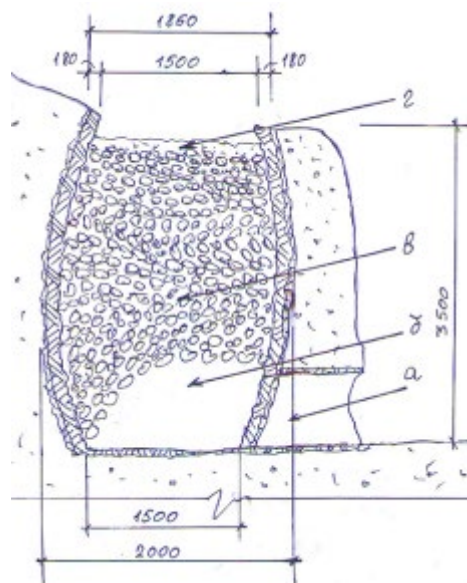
Обмерный эскиз печи для обжига известняка сп. Гули РИ
